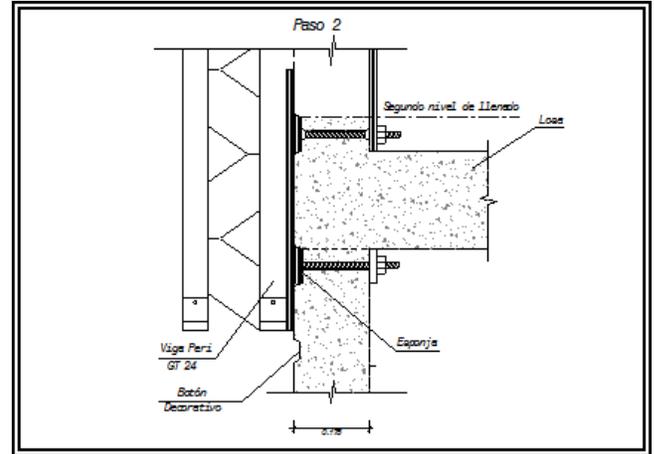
Placa de moldaje con botones decorativos y canterías para tratamiento de junta de construcción en hormigón arquitectónico, marcando con una doble cantería en la cabeza de la losa. (Edificio Fac. de Medicina Universidad de La Frontera) (Autor)
